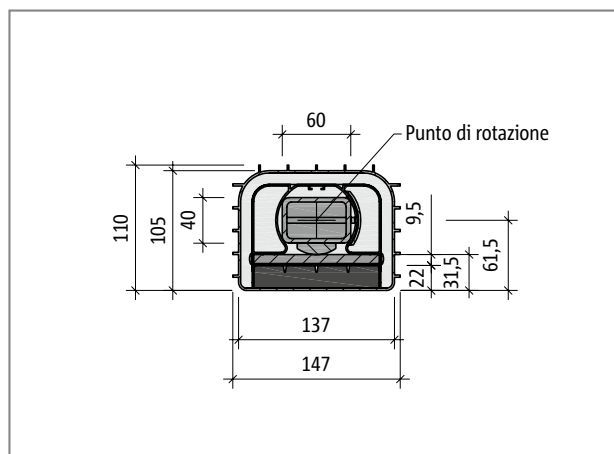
Schöck Tronsole® tipo Q, sezione trasversale dell'elemento B-B con elemento portante orizzontale
